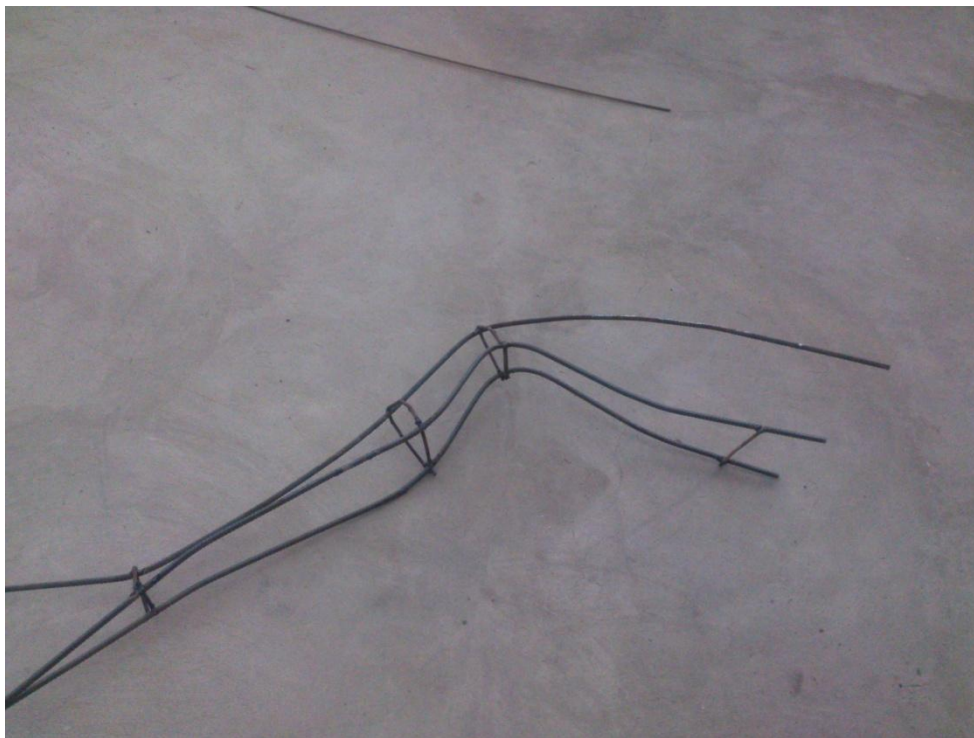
DOBLADO DE BARRAS LONGITUDINALES PIERNA
